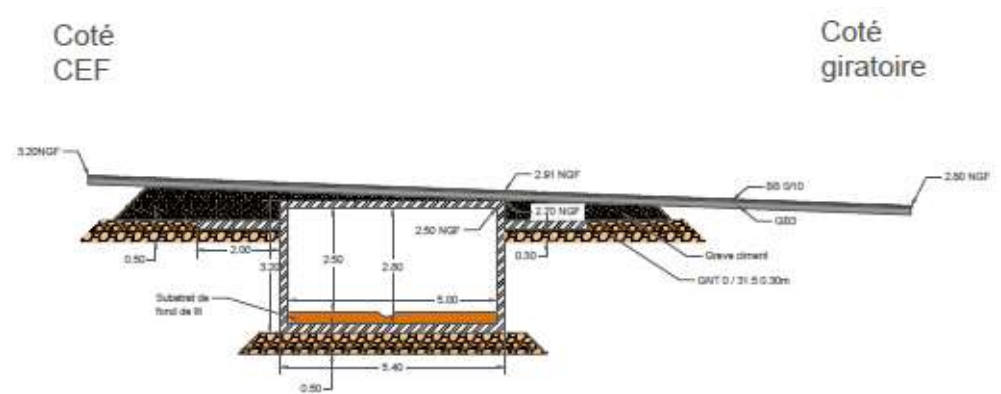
Coupe type de l'ouvrage cadre d'accès au CEF 5 x 2.80 m
